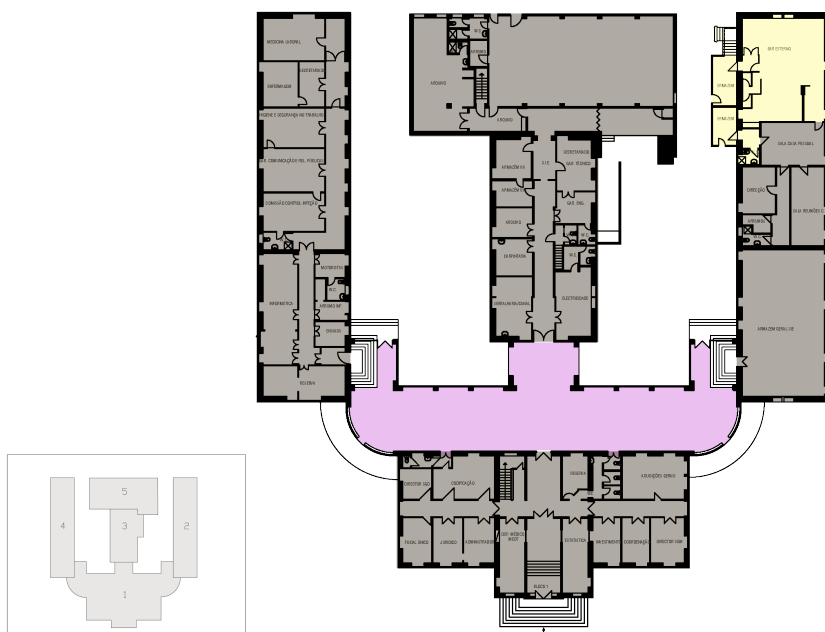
Planta baja bloques 1, 2, 3, 4 y 5. Análisis de usos. En marrón área de acceso restringido a personal autorizado; en rosa, área de extracción de muestras y en amarillo cafetería de acceso público. Plano base oficial facilitado por el Ingeniero Paulo Costa. Análisis gráfico realizado por Laura Castro.
